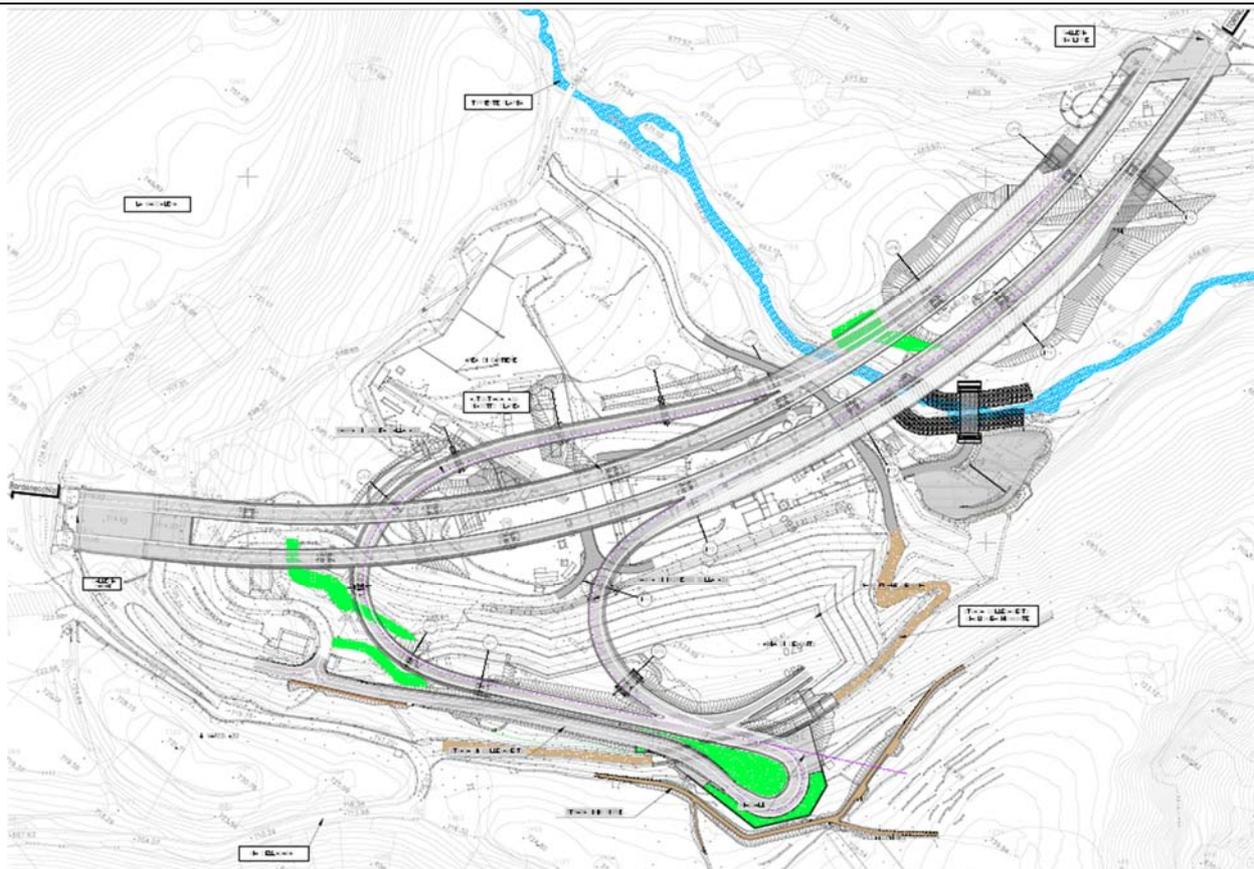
Stralcio planimetrico del progetto definitivo approvato dello svincolo della Maddalena
